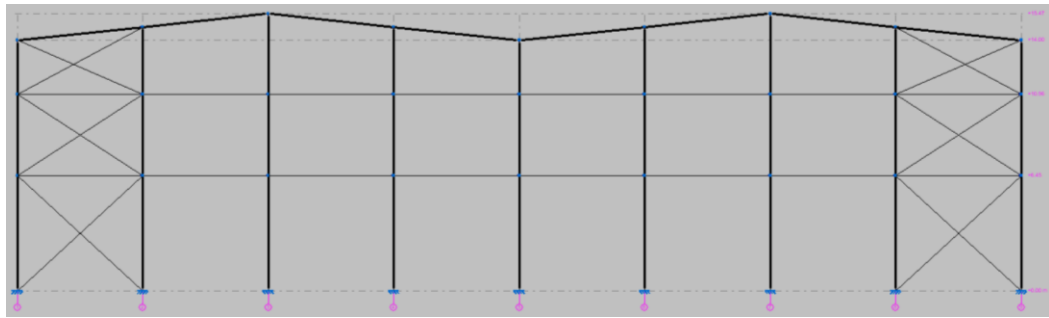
Pórtico de Fachada. Fuente: CYPE
